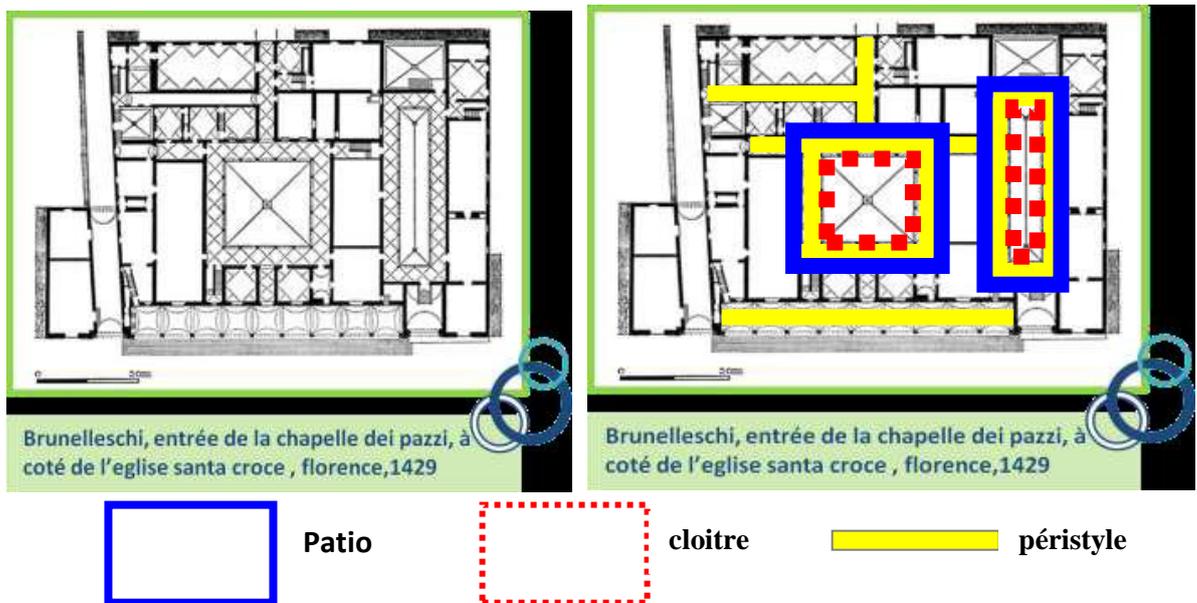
Plan Hôpital de la renaissance Brunelleschi.1429
